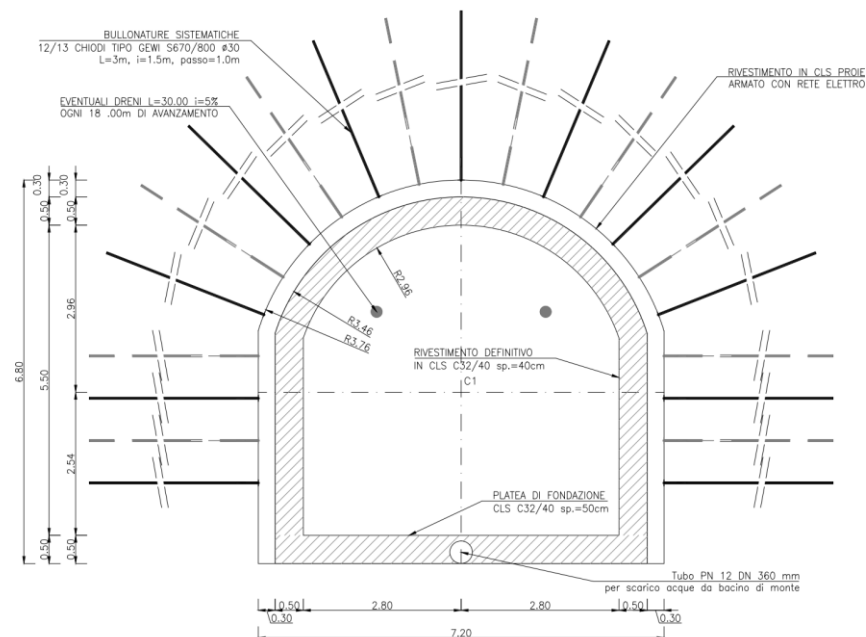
Sezione tipo GS1 del cunicolo sbarre
